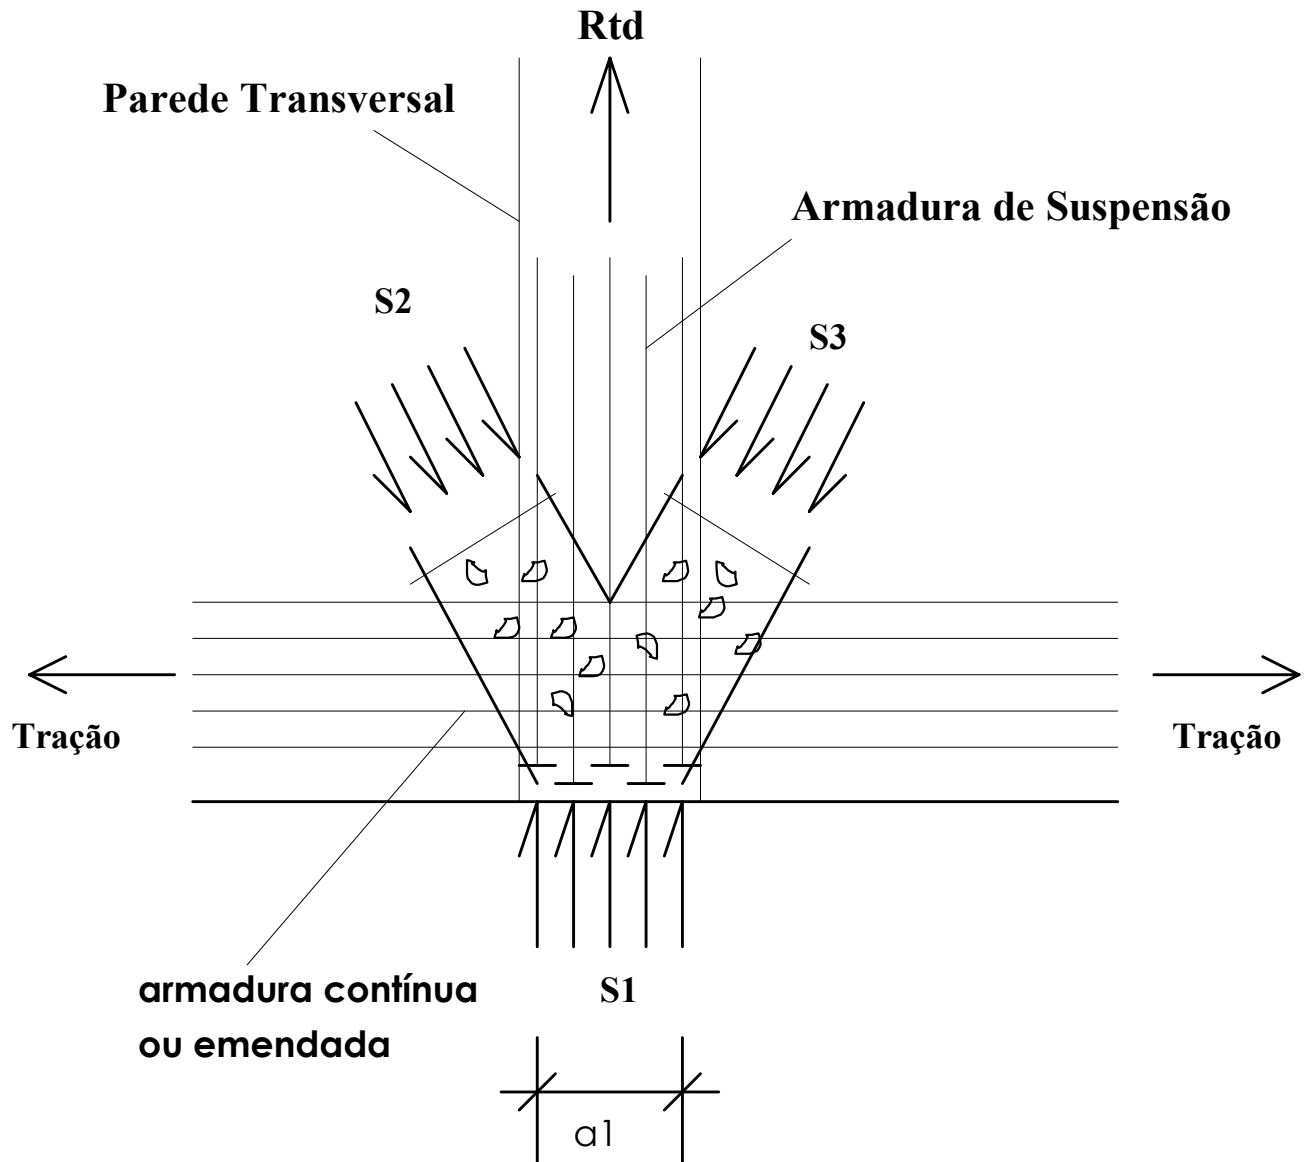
Viga Parede apoiada em outra viga parede transversal, através de uma armadura de suspensão.
